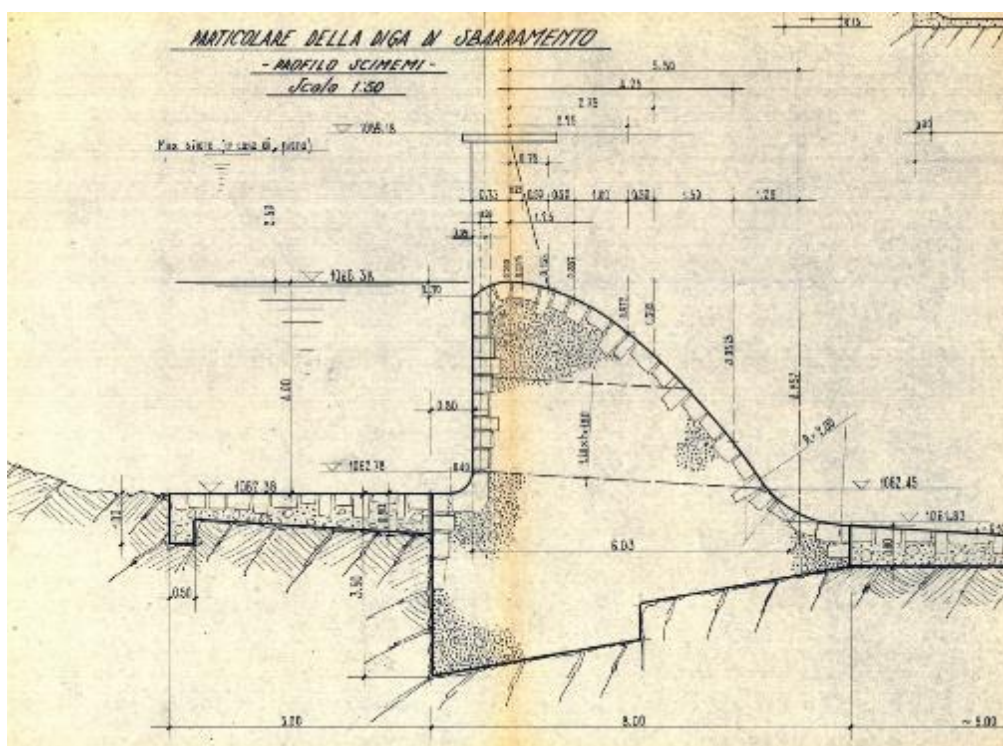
sezione trasversale traversa (disegni 16/10/56)
